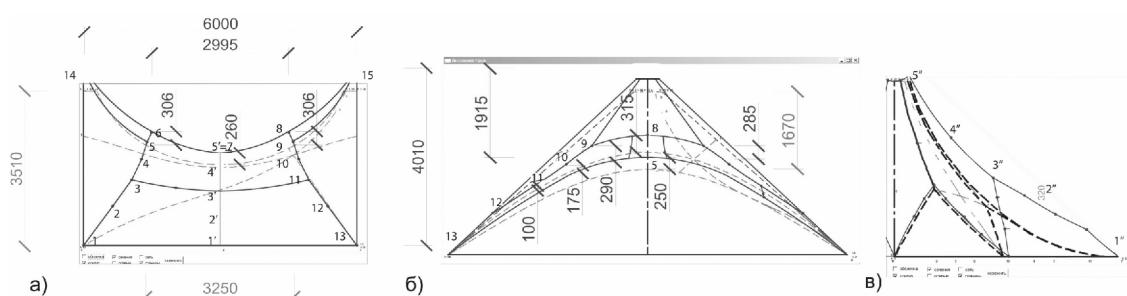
Схема разрезки оболочки на пологие раскройные участки – клинья и характерных отклонений геометрии оболочки от расчетной
